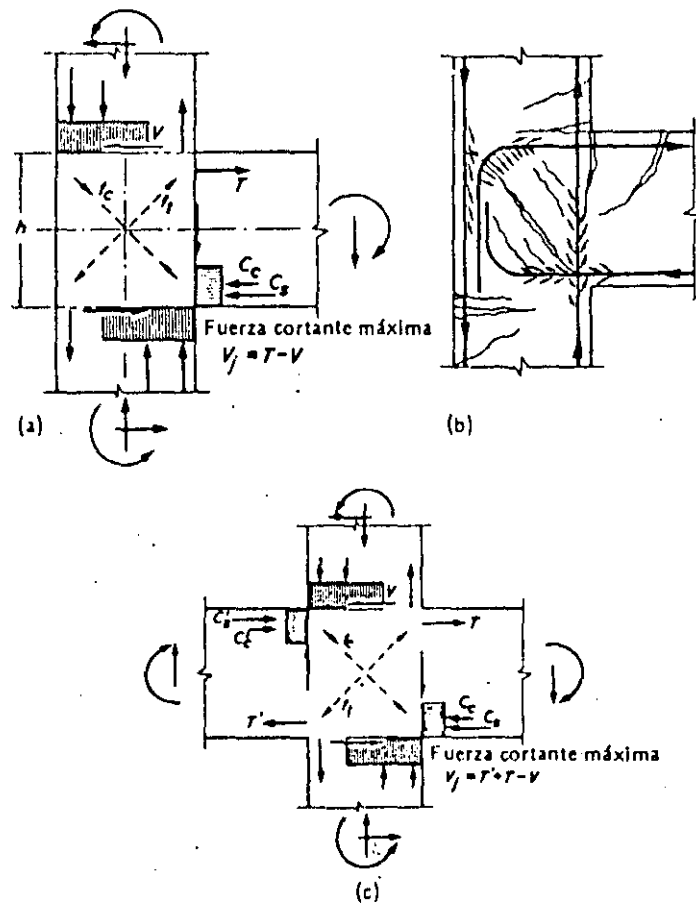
Juntas viga-columna del marco con carga sísmica. a) Acciones y resultantes de los esfuerzos en la junta exterior viga-columna; b) configuración del agrietamiento y fuerzas de adherencia en la junta exterior viga-columna, c) acciones y resultantes de los esfuerzos en una junta interior viga-columna.
